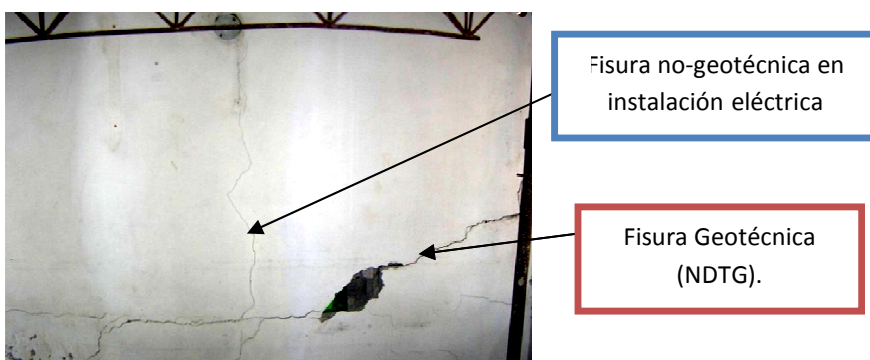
Ejemplo de fisura sobre instalación eléctrica
